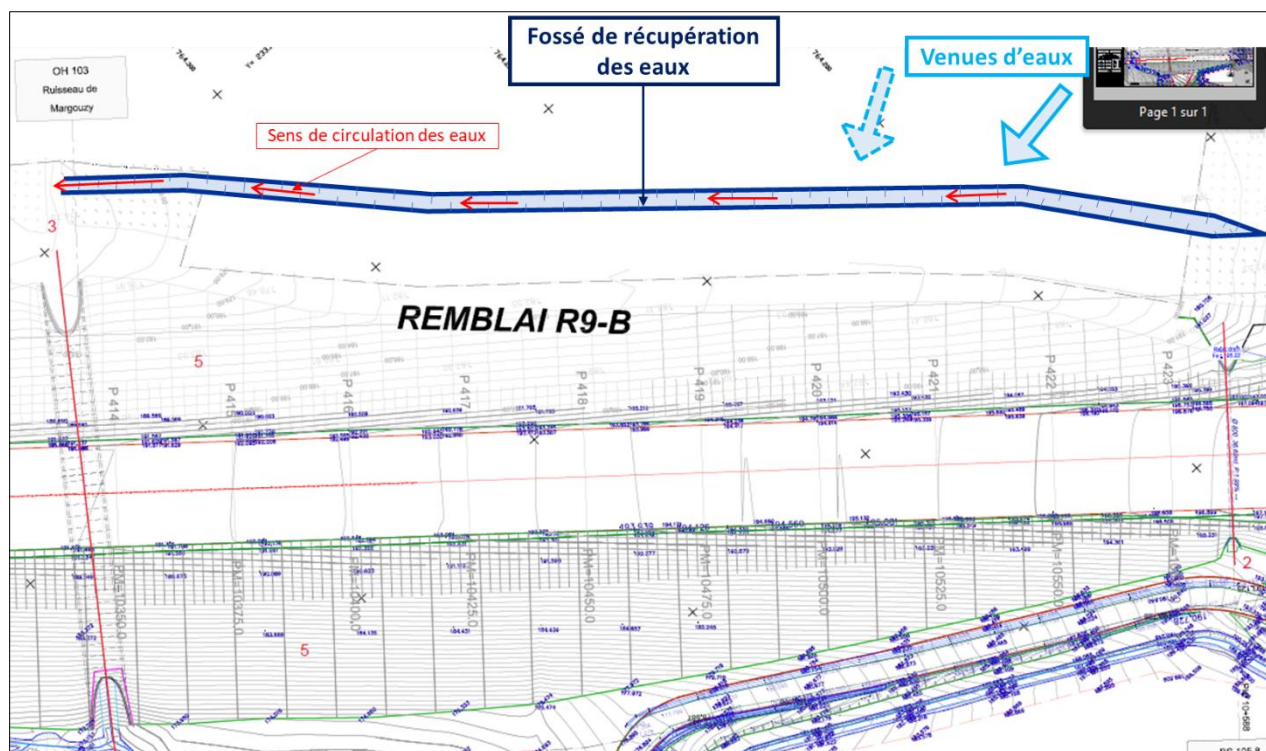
Vue en plan illustrant le principe de fossé drainant à mettre en place au-delà du pied du talus amont
